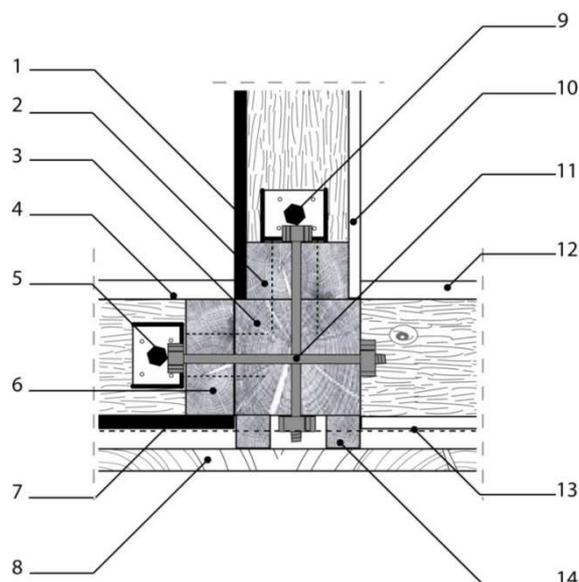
Coupe de principe l'assemblage de murs avec panneaux VT: entre mur un VT de refend et un mur façade avec un panneau VT et un panneau courant.
